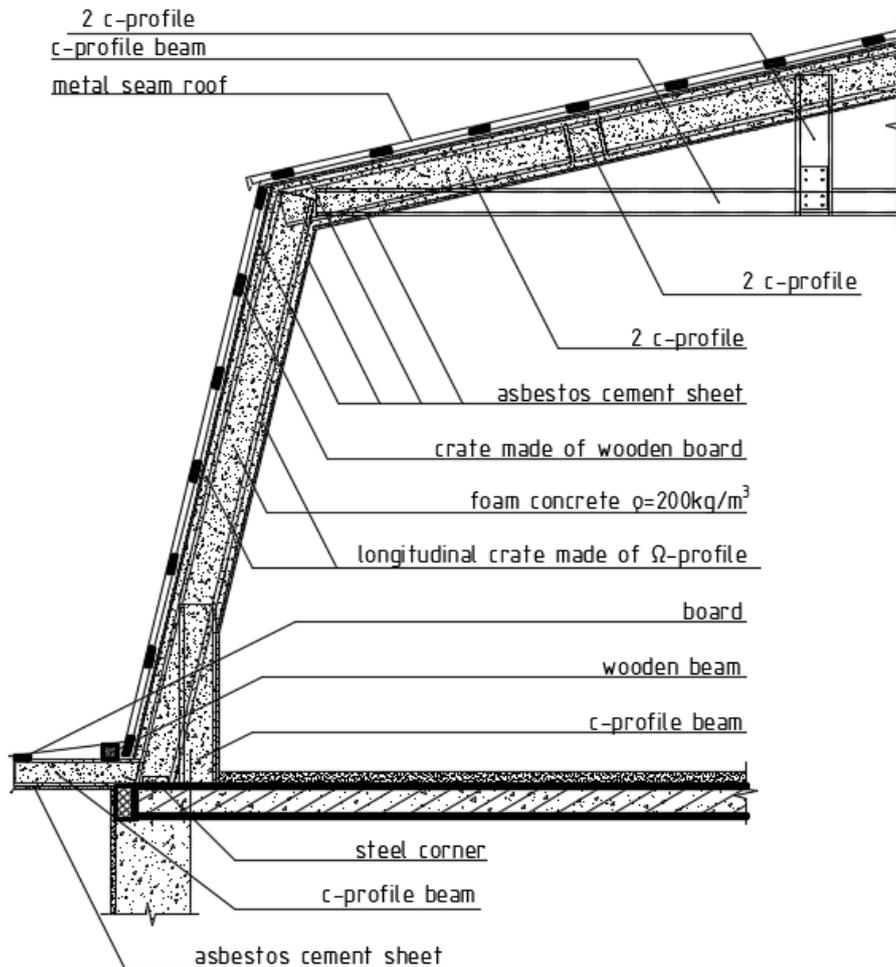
Конструкция мансардной кровли с применением пенобетона
